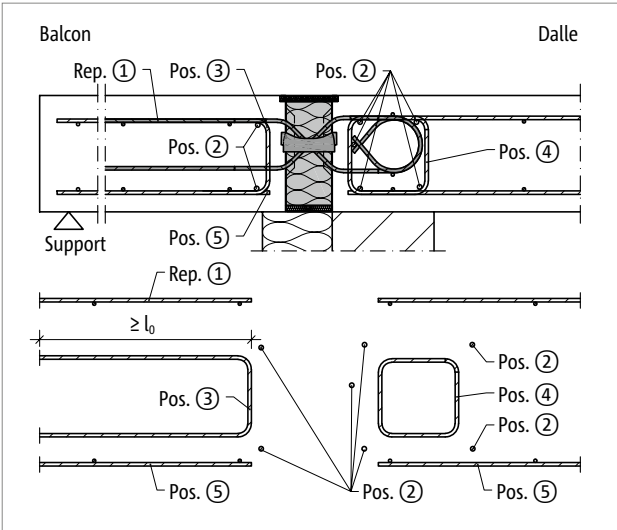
Schöck Isokorb® T Type Q-E-W-VV : Renforcement sur site
